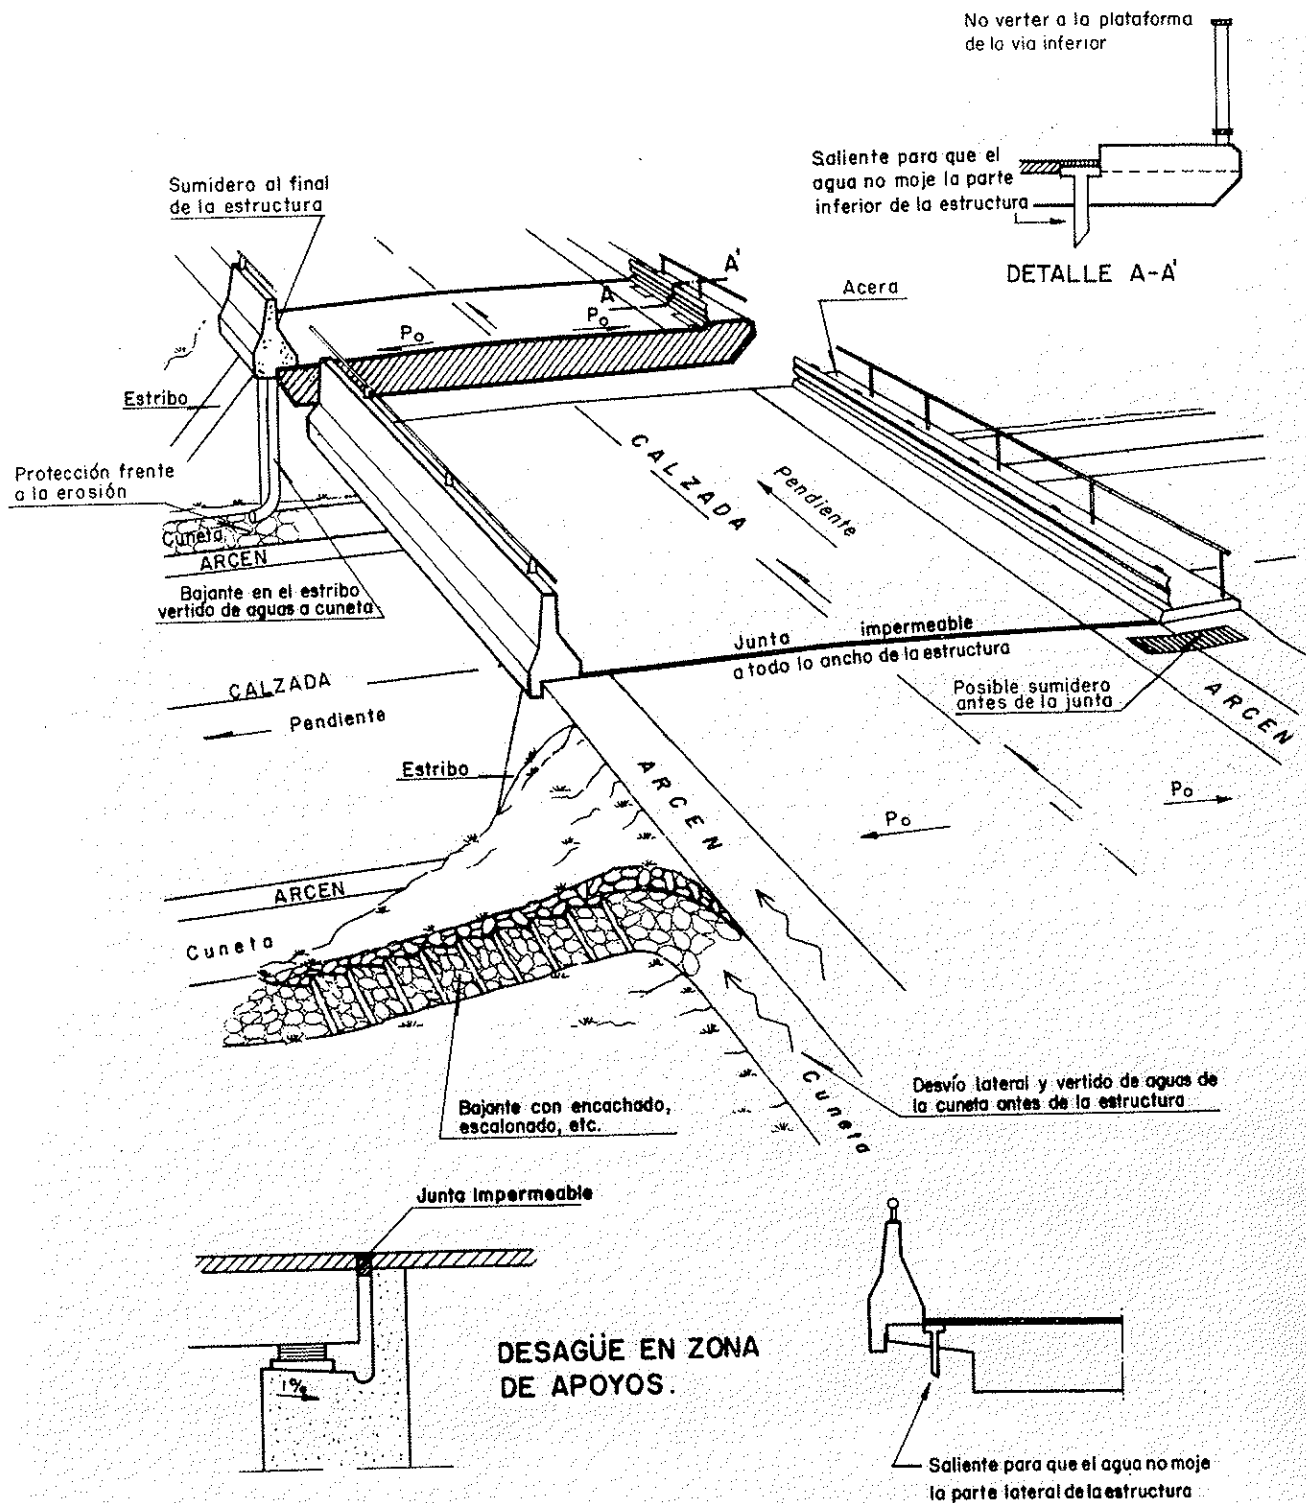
DRENAJE EN OBRAS DE PASO
